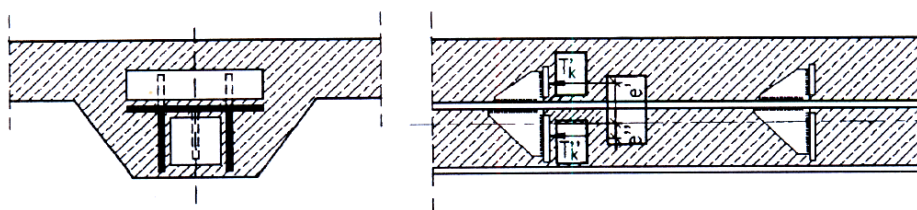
Пример объединение верхнего пояса мостовой фермы с бетонной плитой посредством жестких упоров [7]
